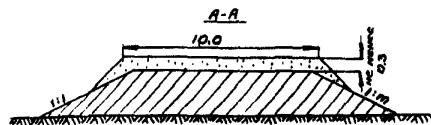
Схема отсыпки первого слоя песчаной подушки из перегрузочного карьера
